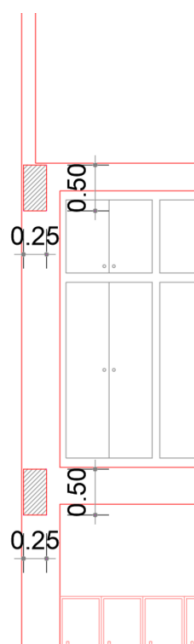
Estudo das dimensões das Vigas de bordo das paredes cegas do Bloco 1.
